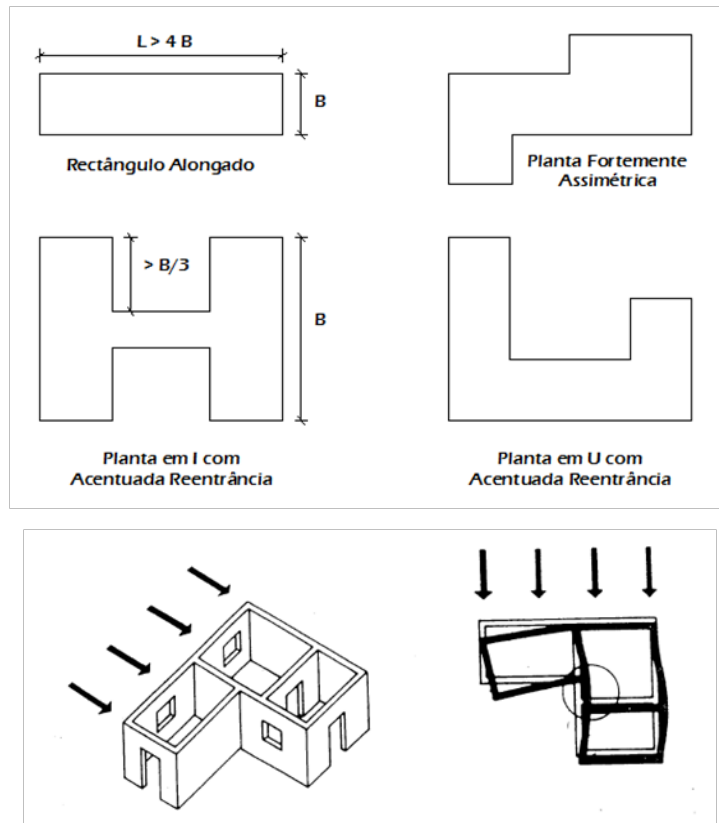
Algumas configurações em Planta a Evitar [15].
